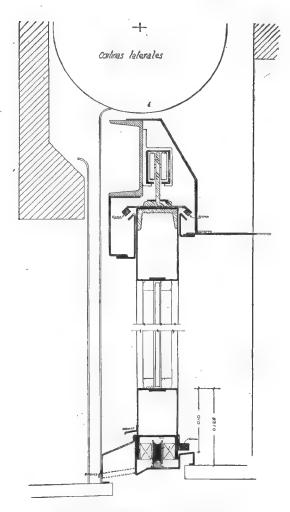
Detalle de carpinteria metálica (aberturas pisos 10 y 22)
